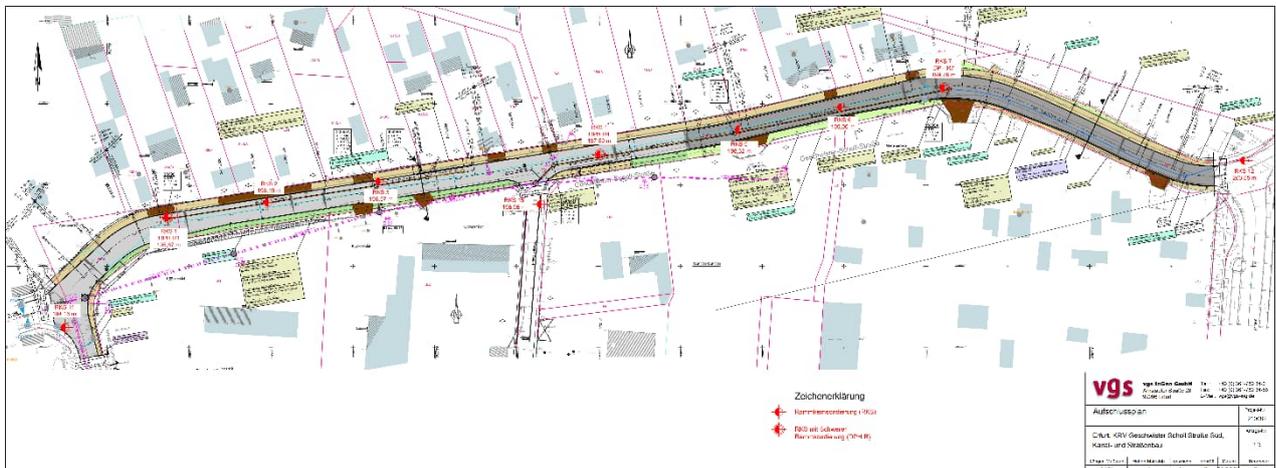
Aufschlussplan aus Anlage 1.3 des Baugrundgutachtens
